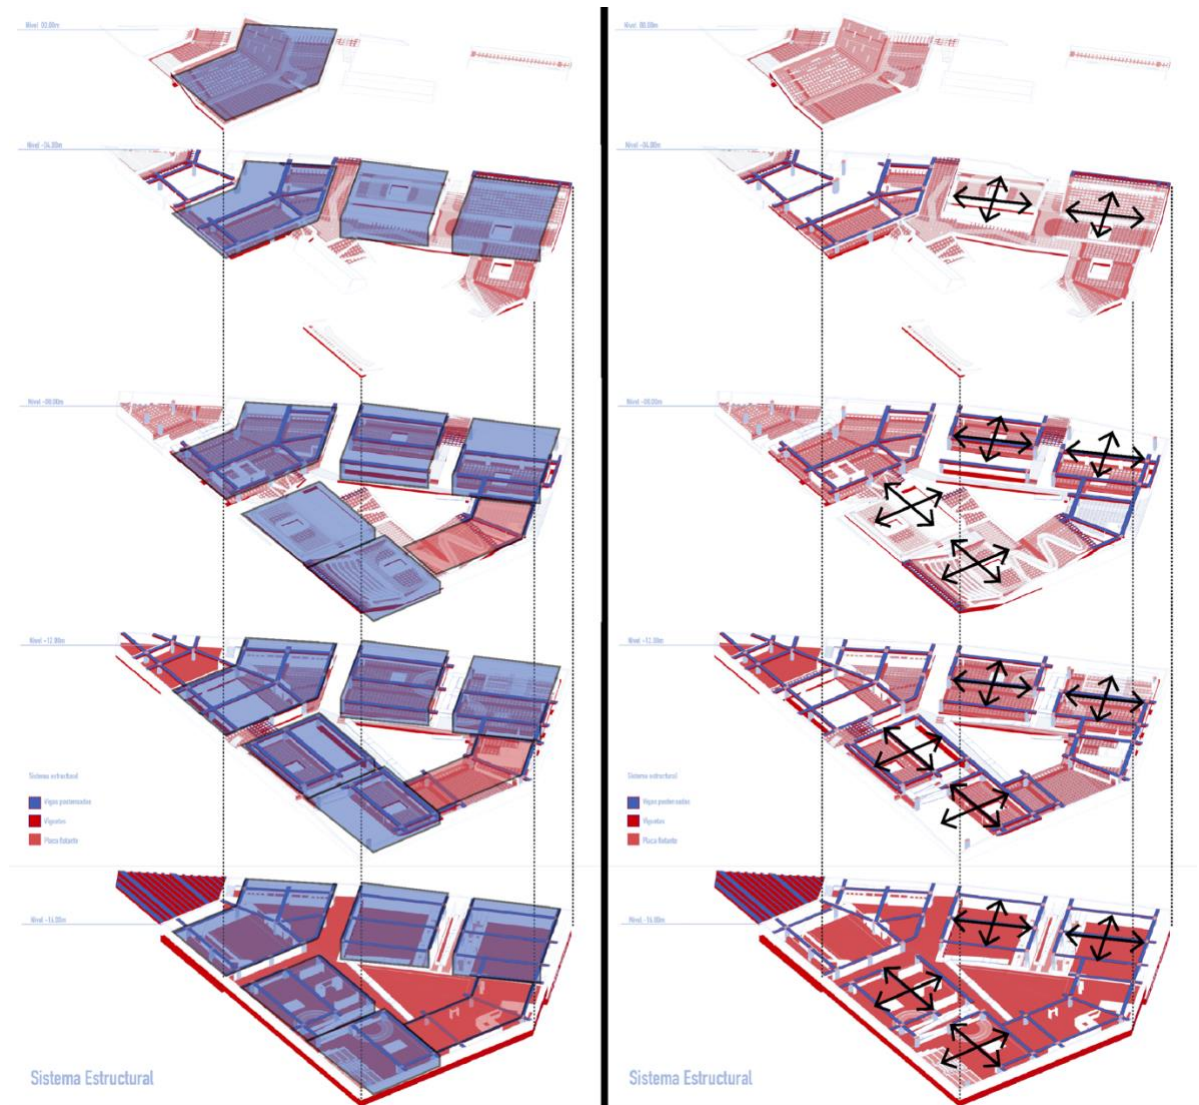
Imagen de sistema de modulación. Fuente: Elaboración propia
